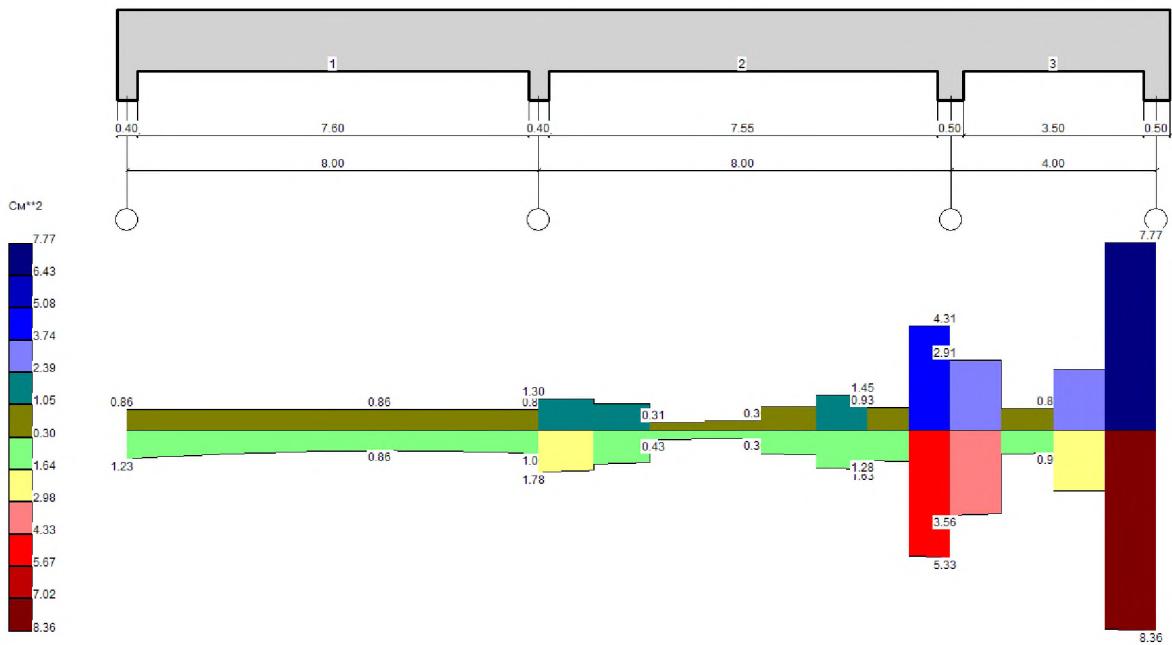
Балка № 2. Епюра поперечного армування
